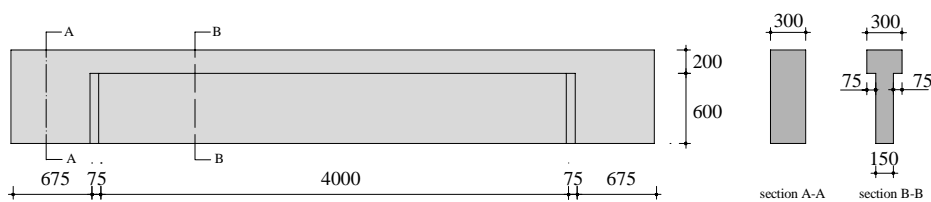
Schema d'une poutre de Braam [Braam90];
